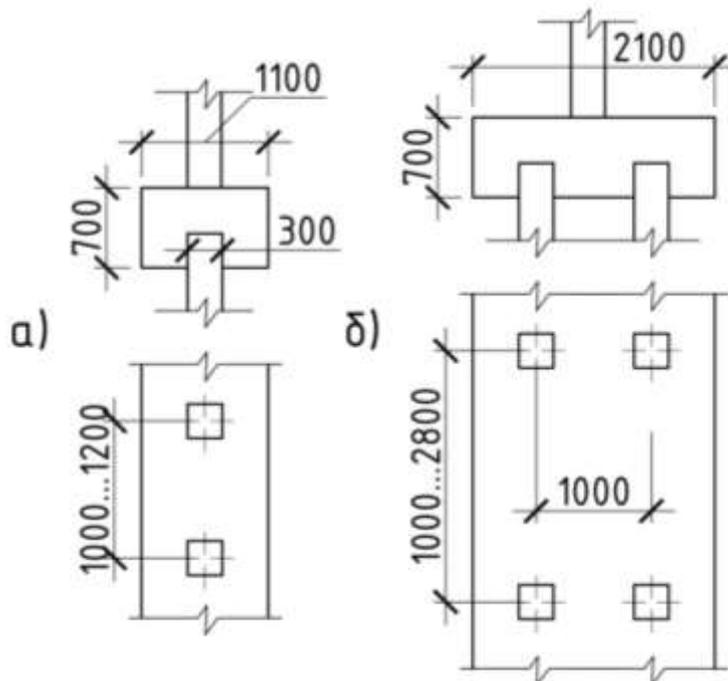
Свайные фундаменты с монолитным ростверком:
